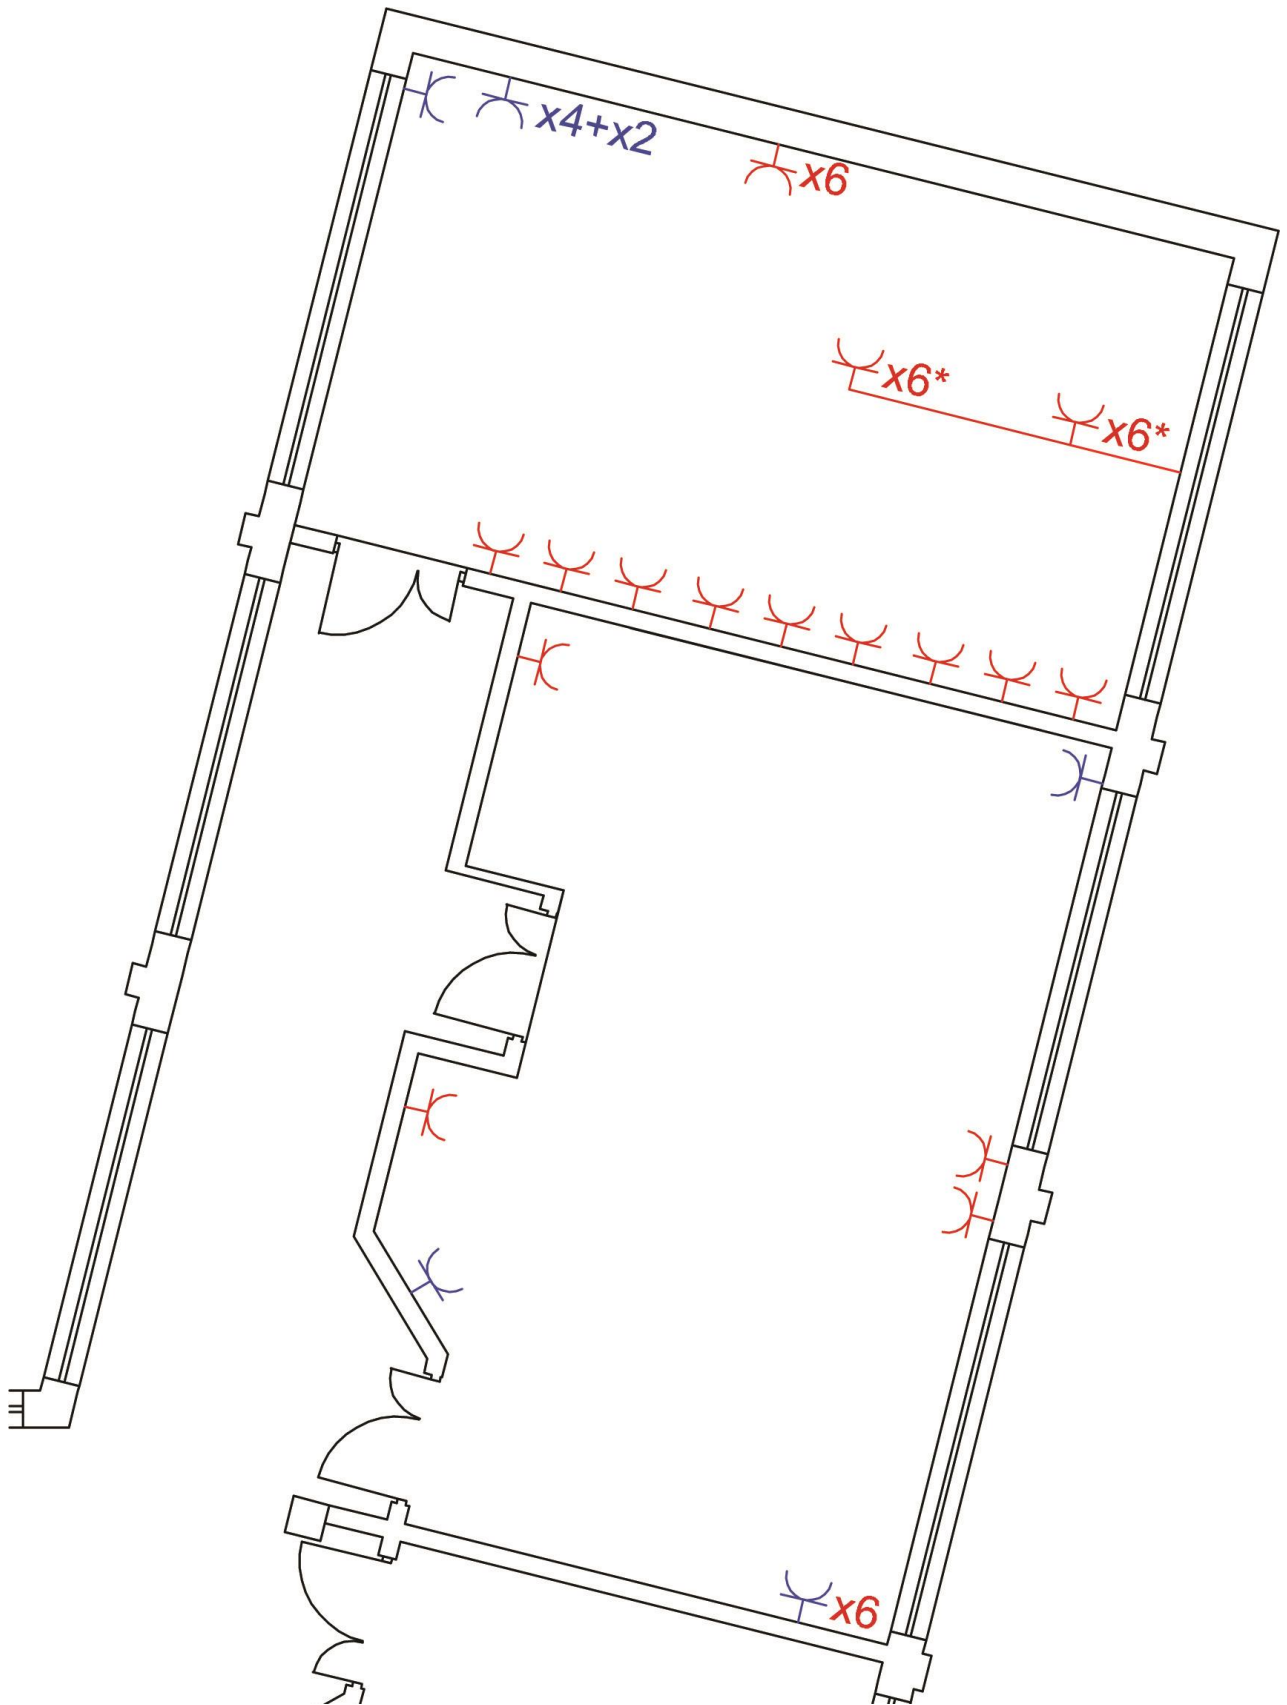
Pianta aula innovativa piano primo_plesso di via Ferrentino
